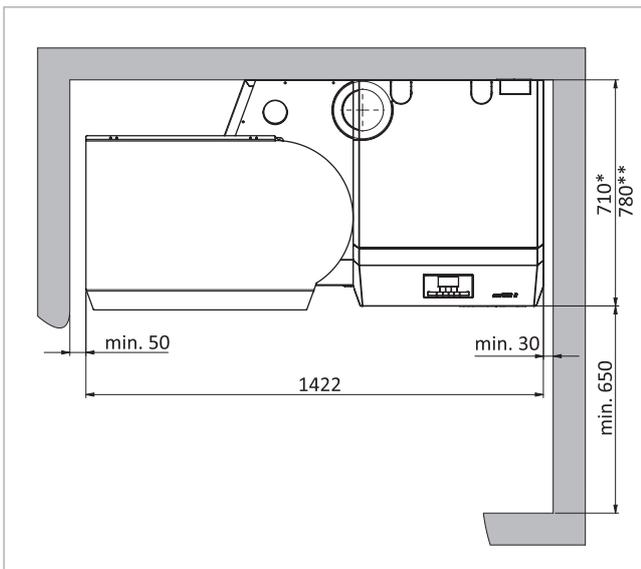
Mindestabstand Rauchgasrohr oben (Maße in mm)
